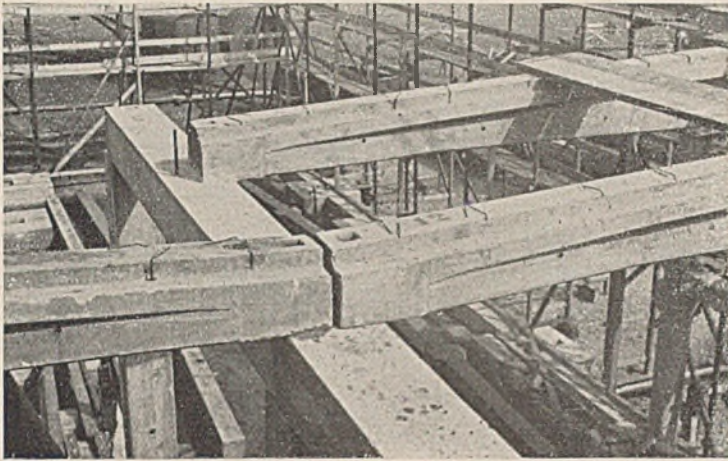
Ausbildung der Dachträgerauflager mit Verankerung durch Schraubenbolzen.
